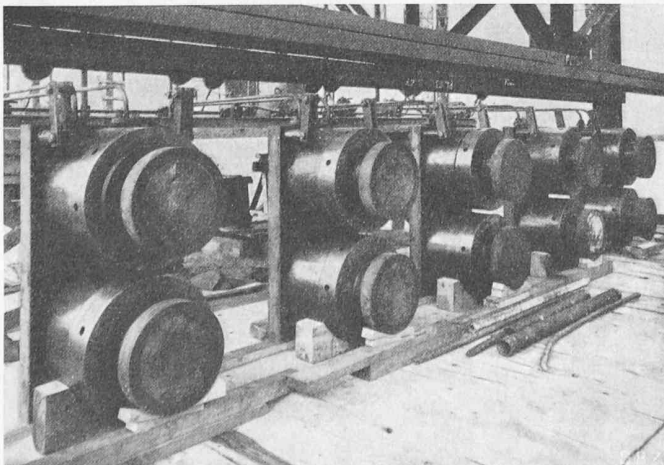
Hydraulische Winden im Scheitelpunkt vor dem Betonieren
